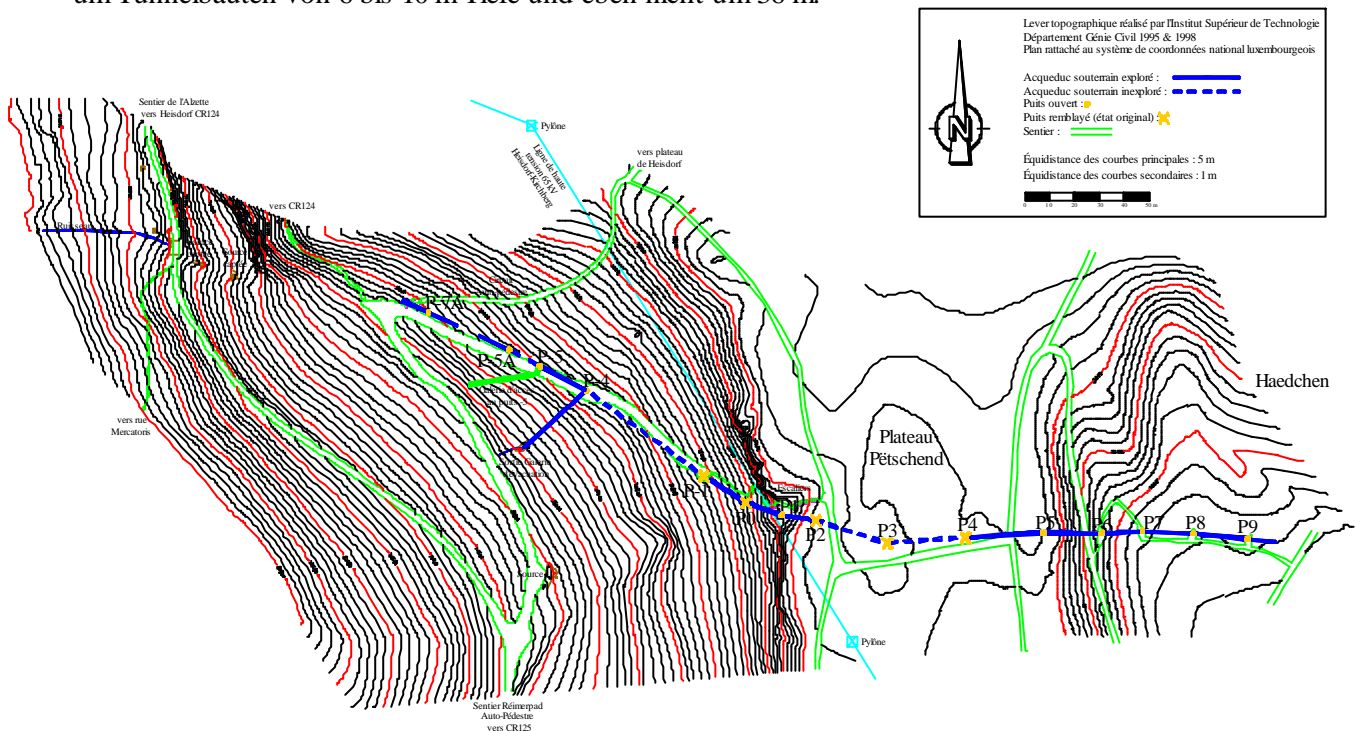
Lageplan der gesamten aktuell bekannten Situation mit der unterirdischen Wasserleitung
